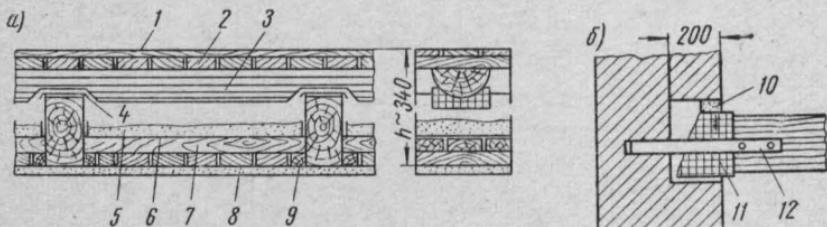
Трудносгораемое перекрытие по деревянным балкам
